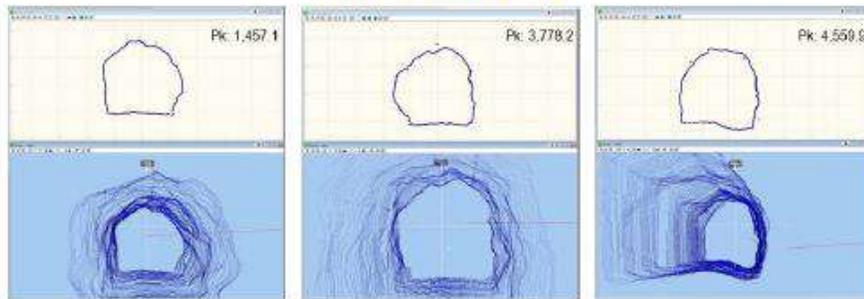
Secciones transversales correspondientes a sección alternativa 2 observadas a lo largo de la inspección.
